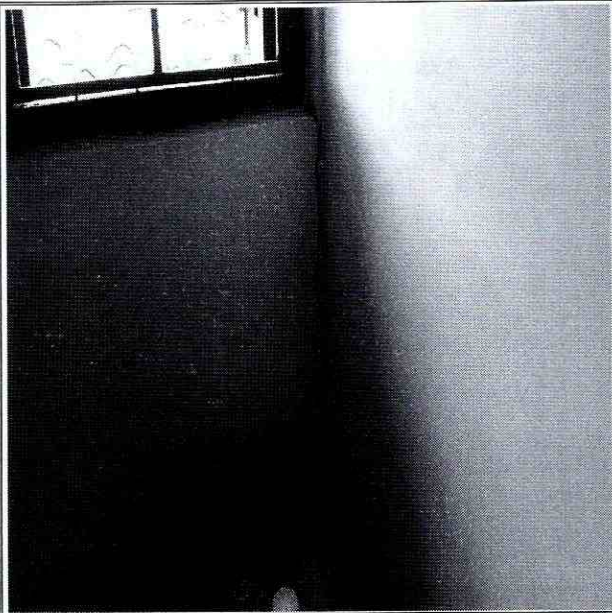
Grietas muro divisorio segundo nivel de la vivienda
